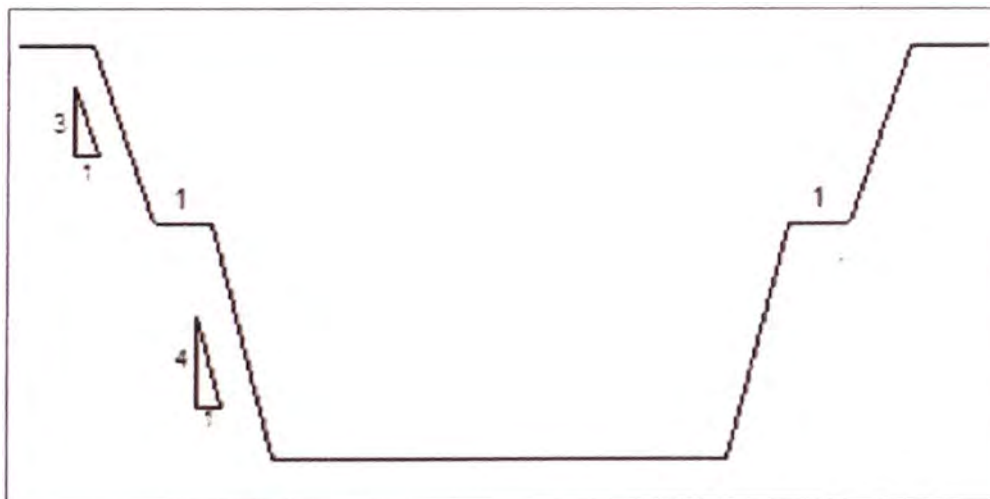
Taludes de excavación de las zapatas - Sección transversal
